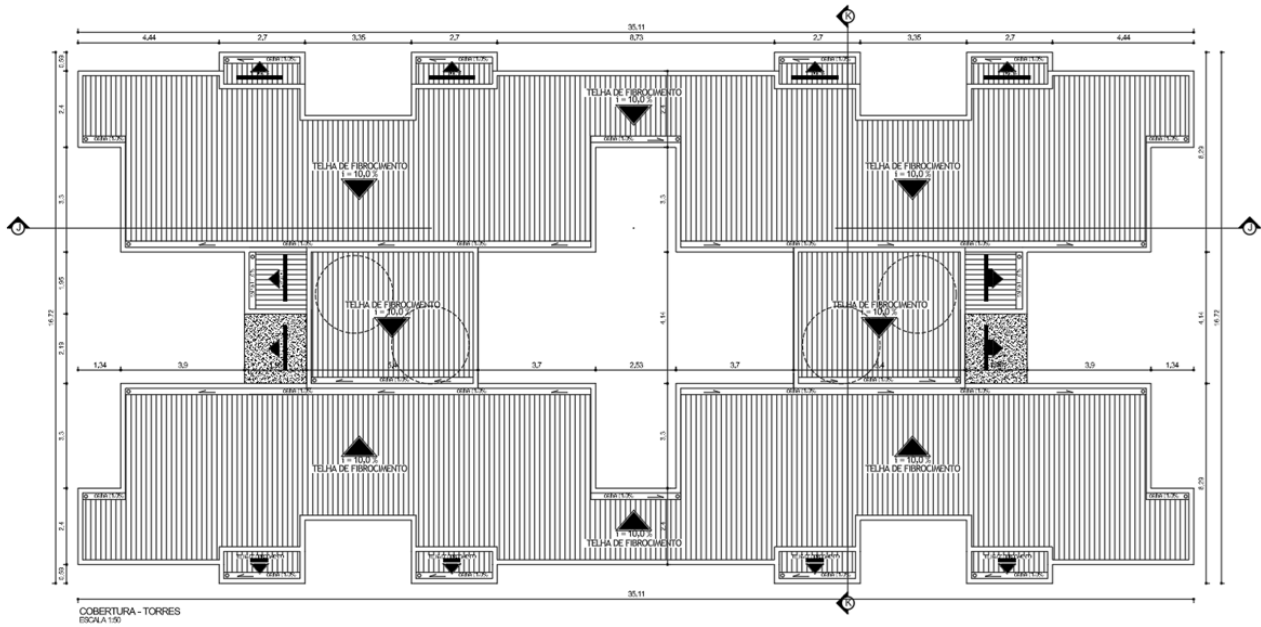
Planta de Cobertura. Fonte: LM5 Construtora
